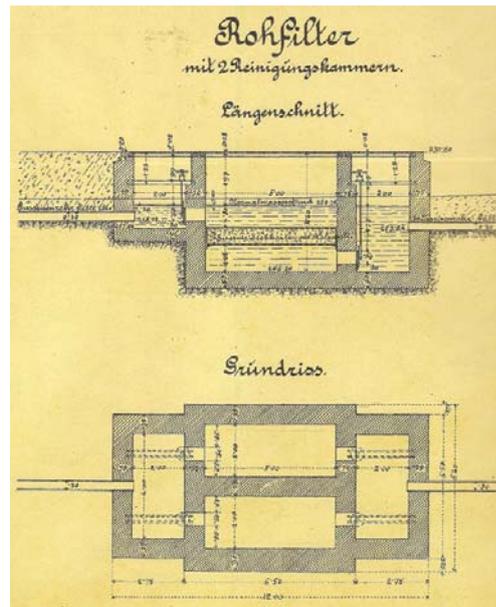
Rohfilteranlage, Ausführungsplan 1904
